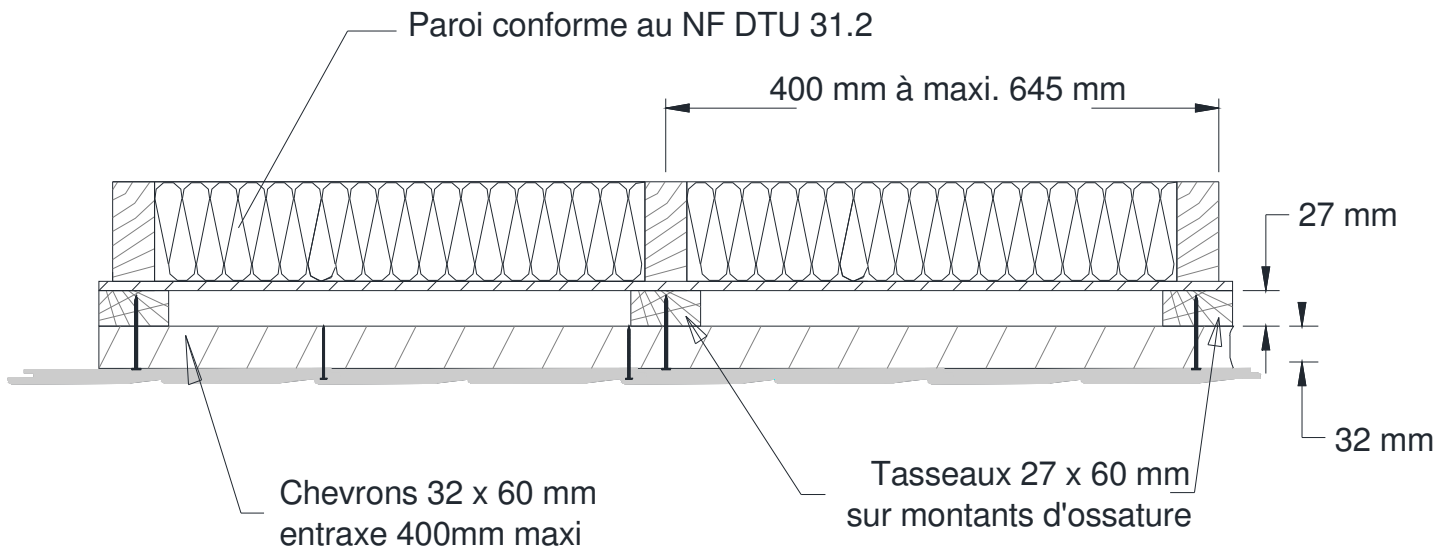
Coupe horizontale sur COB – Pose verticale – pose sur double chevronnage
